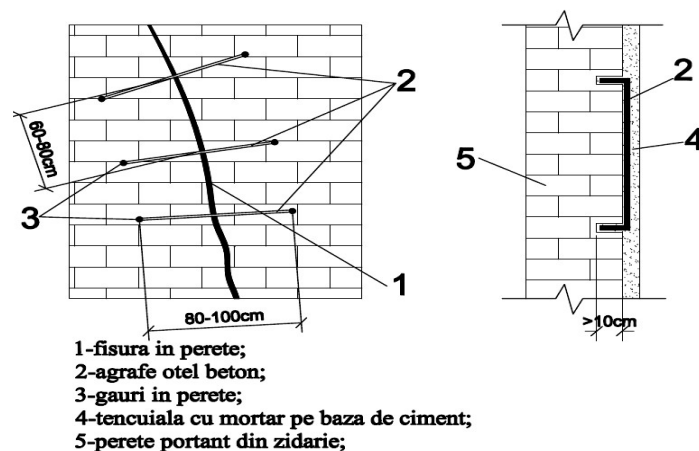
Consolidarea zidăriei cu agrafe din oțel-beton.
